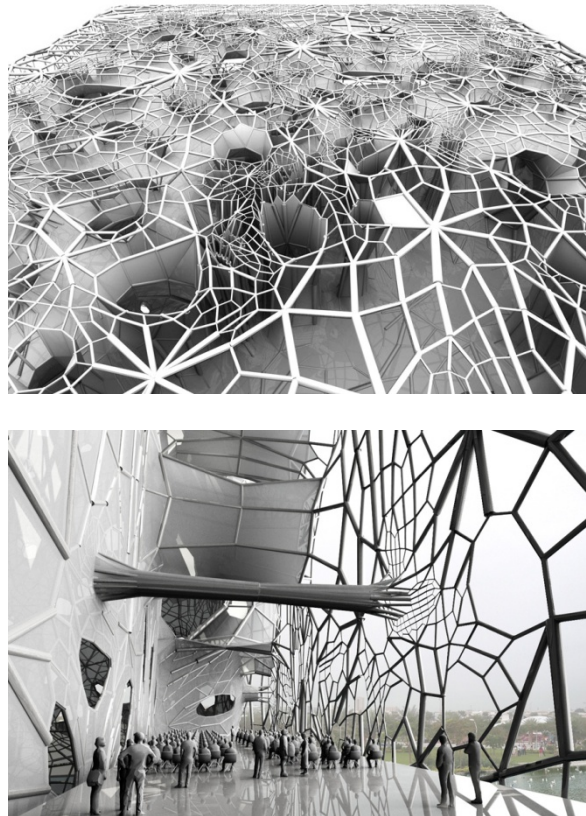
Fuente: Faulders Studio: GEOTUBE TOWER, Dubai, UAE_2009. En: <http://faulders-studio.com/GEOTUBE-TOWER>
